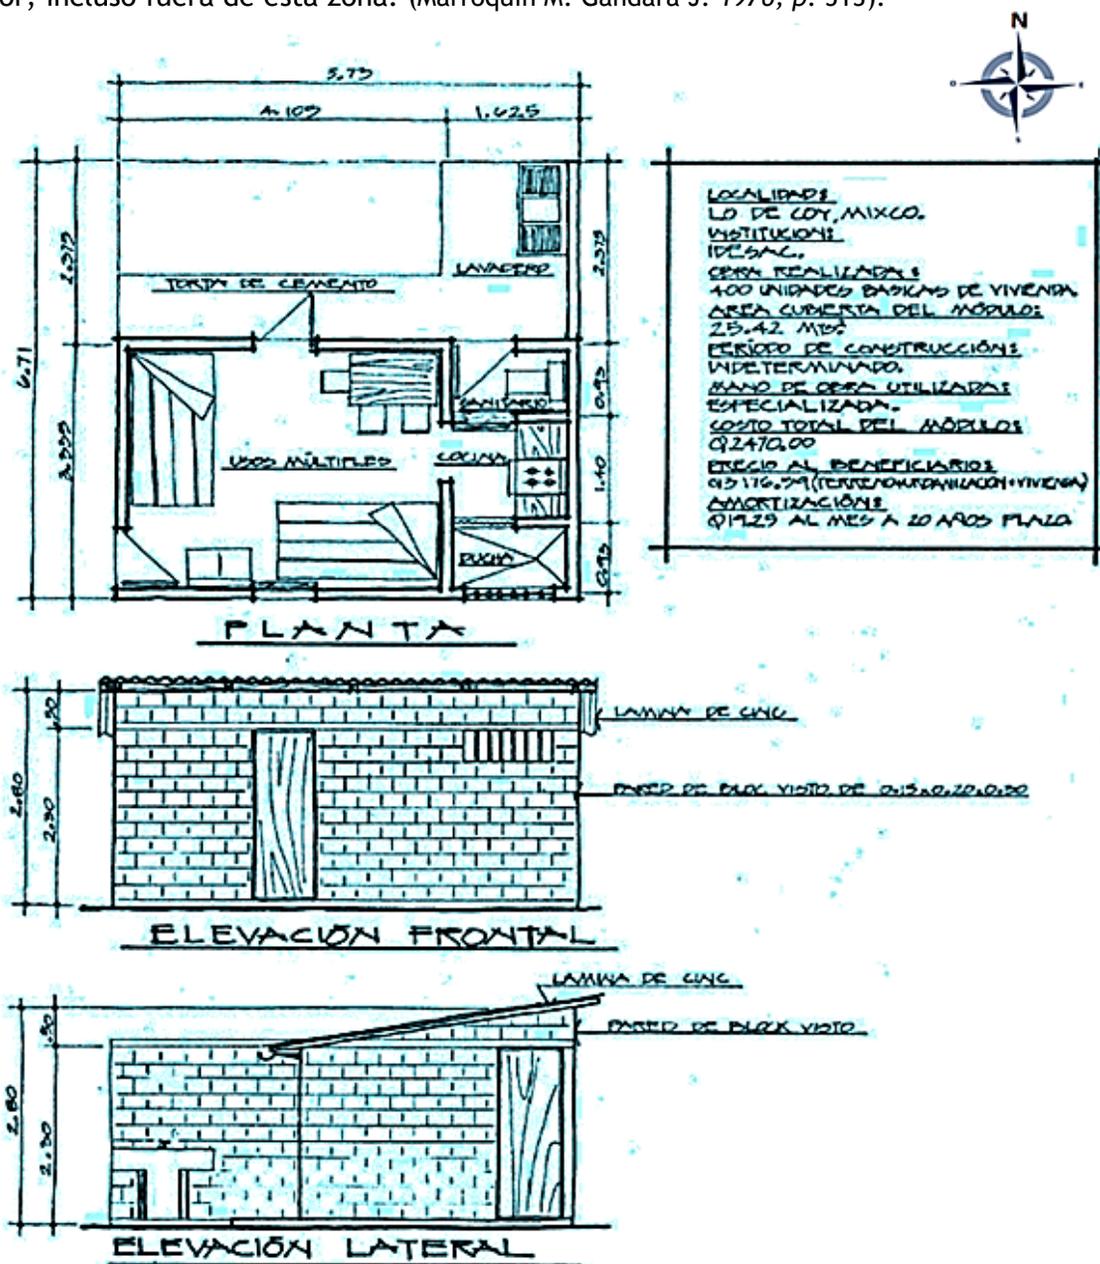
Planta y elevaciones de vivienda para Aldea Lo de Coy, Zona 8 de Mixco. (Marroquín M. Gándara J. 1976, p. 513).
